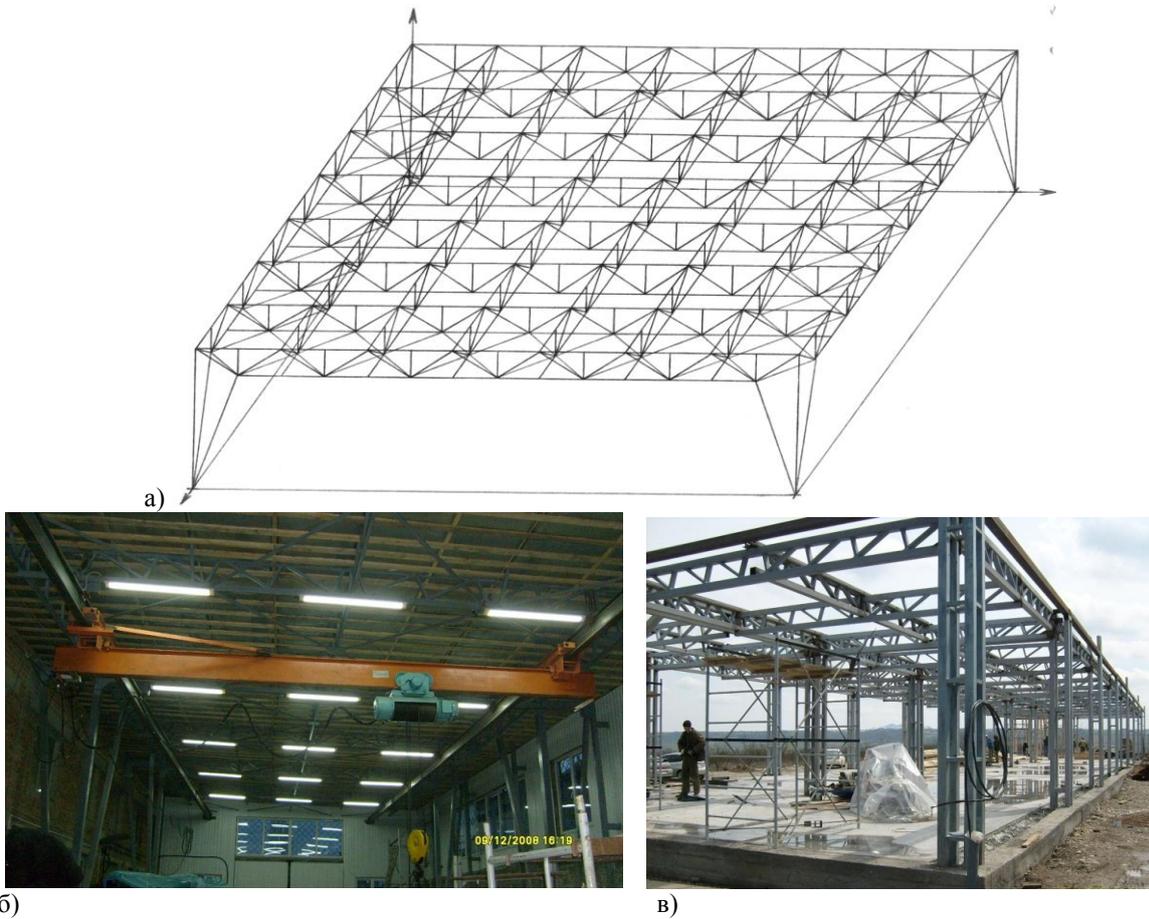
Общие виды каркасов из перекрестных систем: а – расчетная схема; б – с опиранием на V-образные колонны; в – с опиранием на многоветвенные (4-ветвенные) колонны
